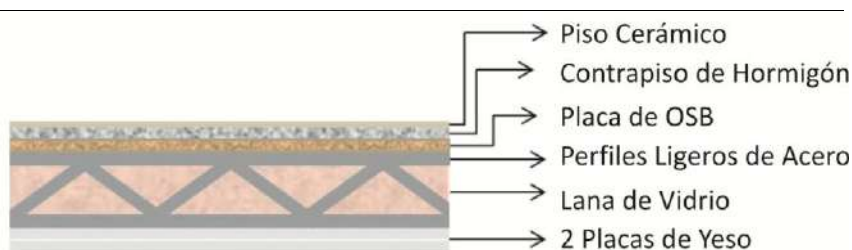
Corte del sistema de entrepiso – cercha metálica, placas de OSB y contrapiso de hormigón.
